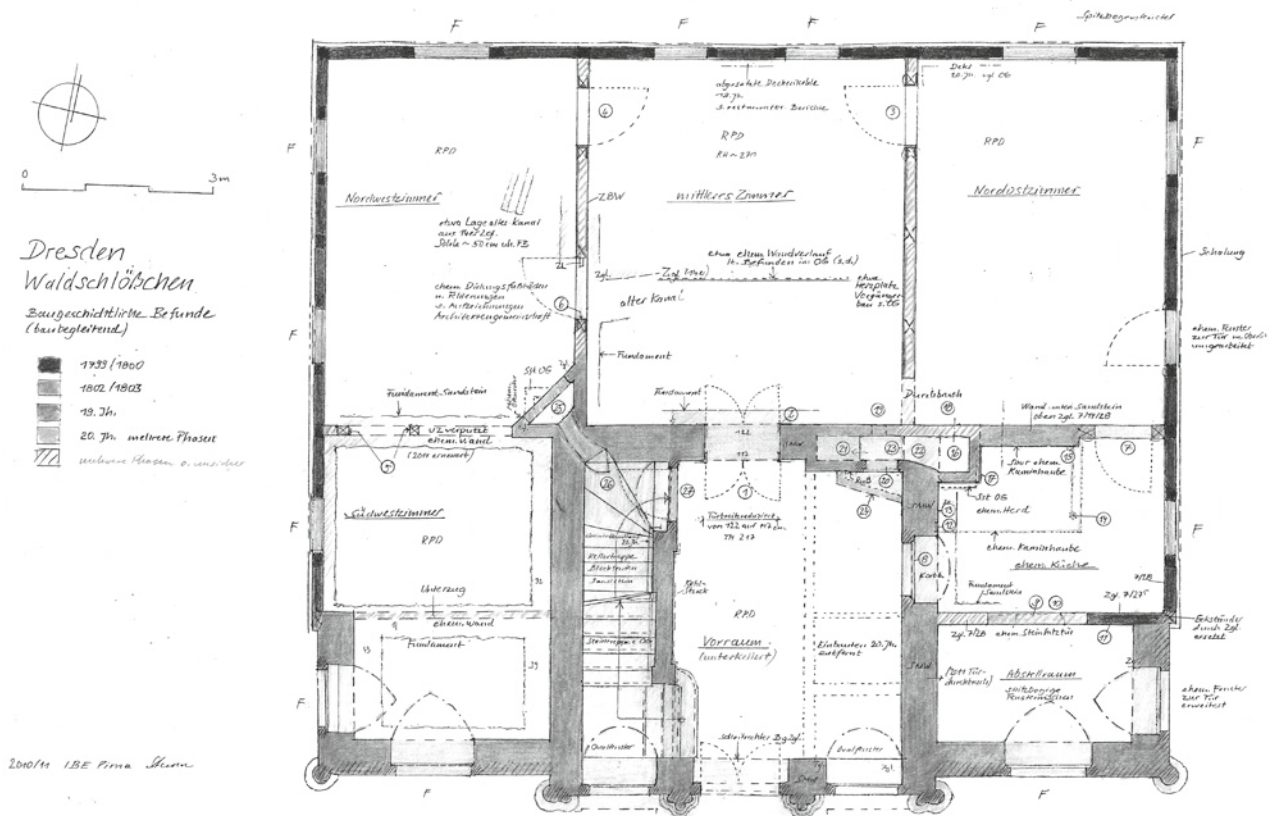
Grundriss EG (baugesch. Bestandsaufnahme) mit dem Mauerwerk von Südseite, Vorhalle und Treppenhaus sowie die dünnen Fachwerkwände der übrigen Gebäudeseiten
